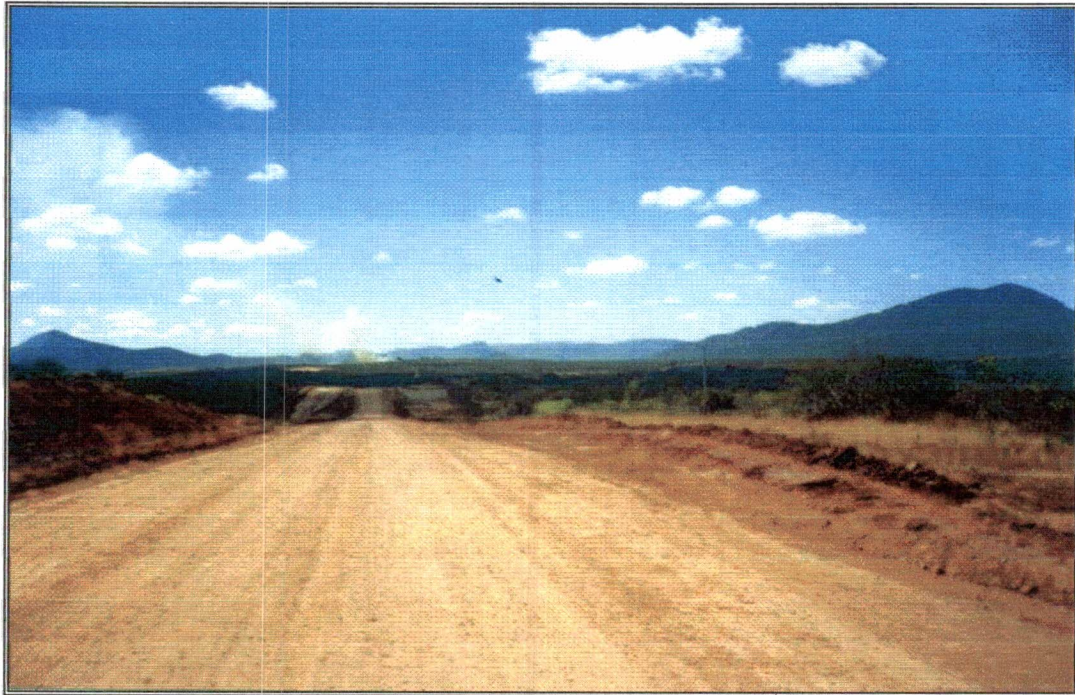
Aspecto do Desvio da CE – 166, após o revestimento primário.
